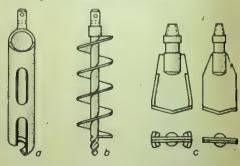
a Schappe und b Spiralbohrer für bindige Schichten, c Blattmeißel für feste Gesteinsbänke
